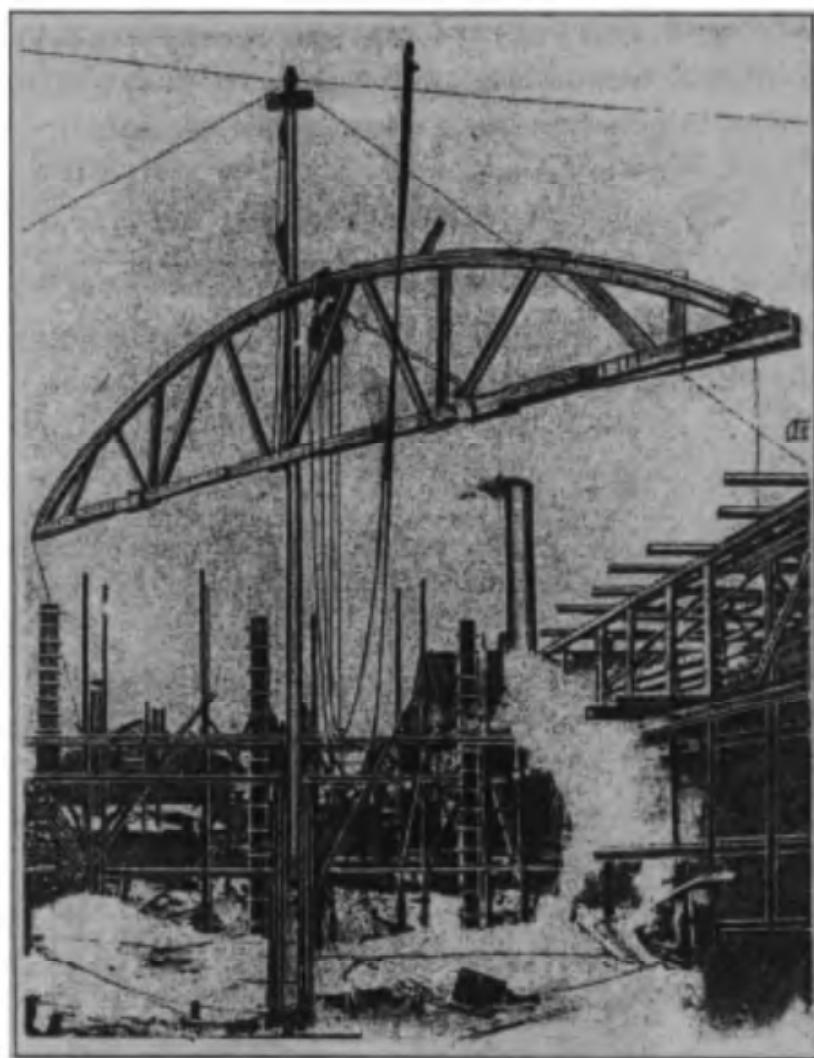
Монтаж клееной сегментной фермы при помощи мачты
